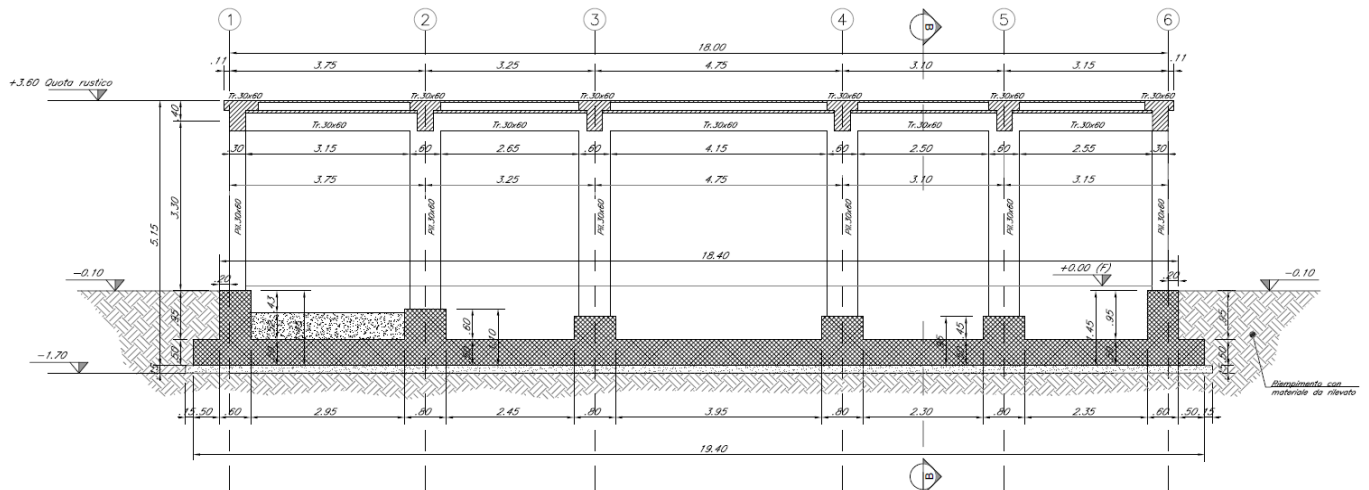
Carpenteria fondazione Fabbricato tipo A
